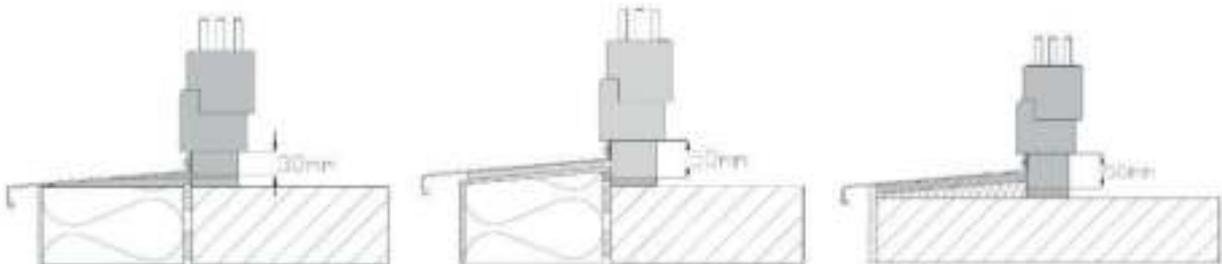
schematische Darstellung möglicher Fensteranschlussprofilhöhen (links: Montage während der Fassadenarbeiten – FB eingeputzt; Mitte: nachträgliche Montage Fensterbank – WDVS an Basisprofil angeschlossen; rechts: monolithisches Mauerwerk)
